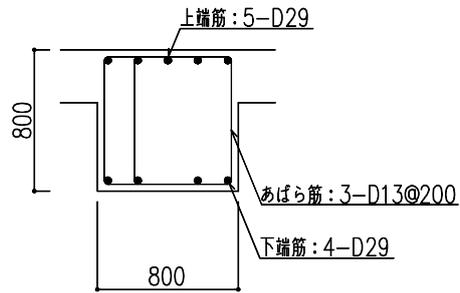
大ばりの配筋図（屋上階，X2 通り YK～YL 通り間，端部）（単位：mm）
